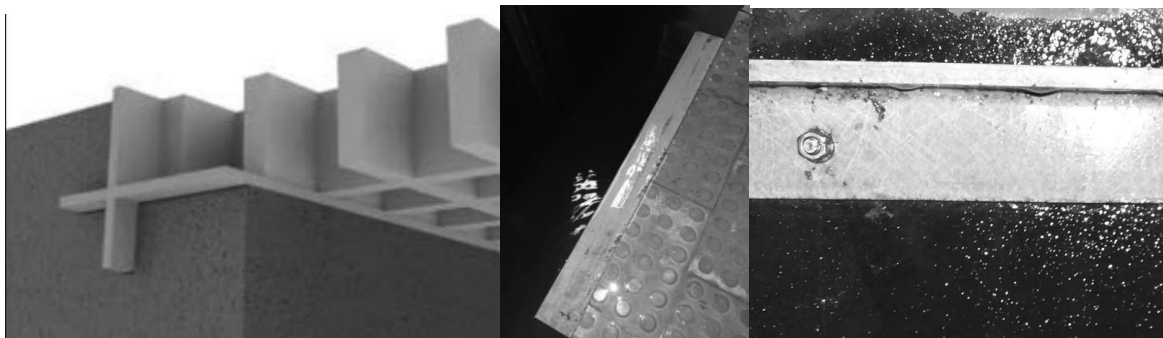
Exemplo de calha embebida no betão e de cantoneiras fixas no betão.
